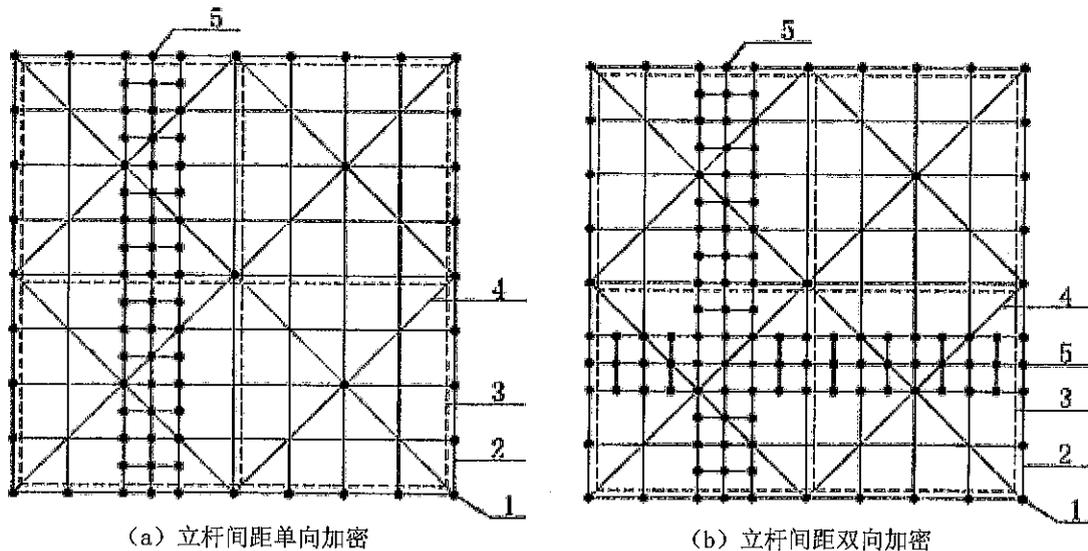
有剪刀撑框架式模板支撑结构的立杆加密平面图
